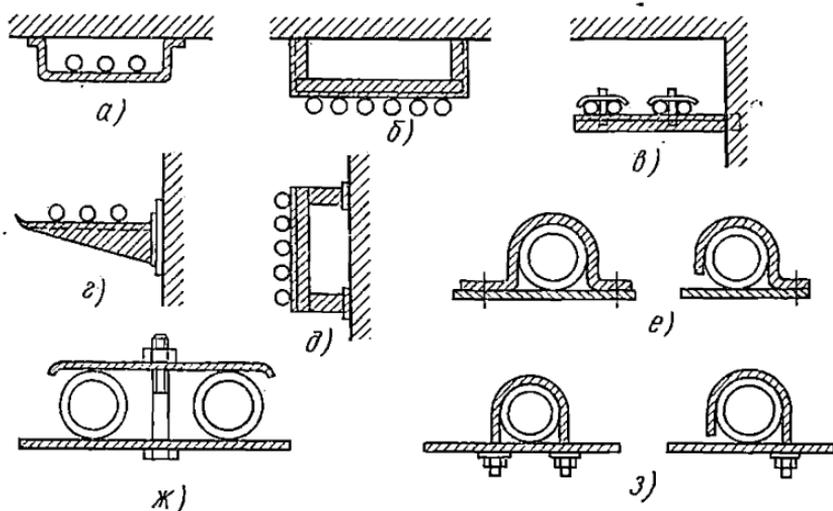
Опорные и крепежные конструкции для трубных электропроводок:
